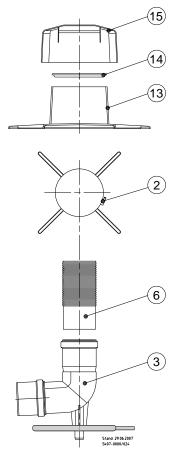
Detail-Zeichnung Befestigung Schachtabdeckung
